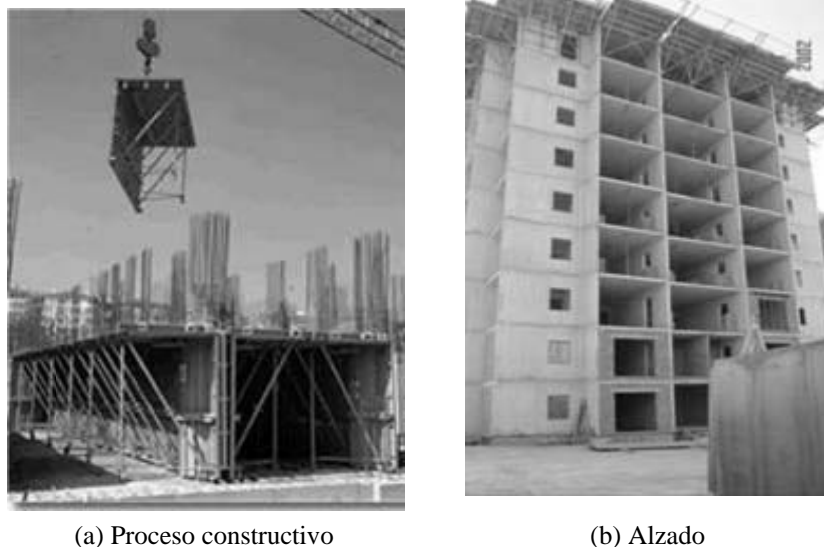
Edificio típico con encofrado túnel en Turquía [Yakut y Gulkan, 2003]
